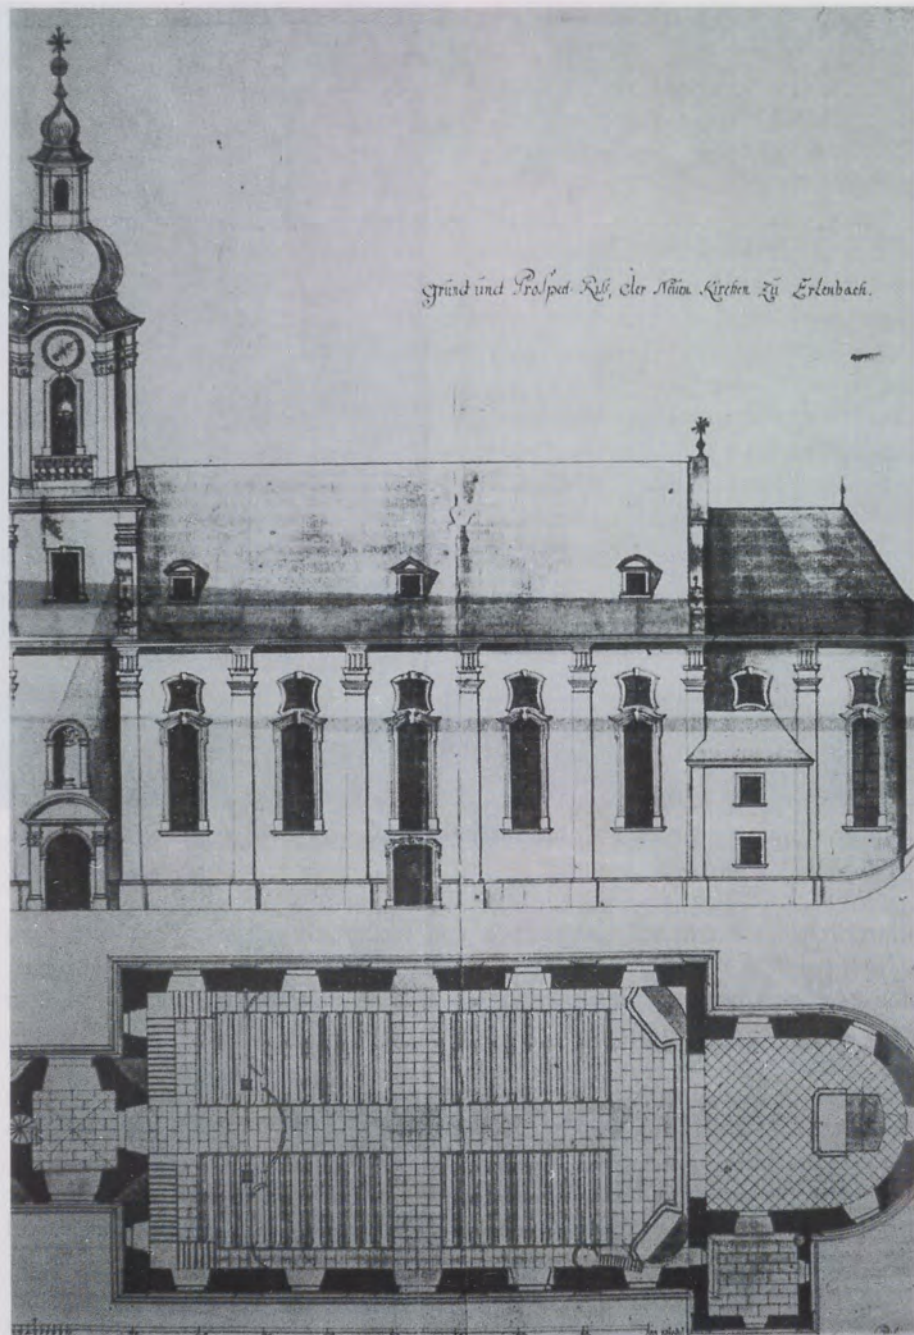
Grundriß und Ansicht der Pfarrkirche in Erlenbach. StAL B 267 Bu 318
